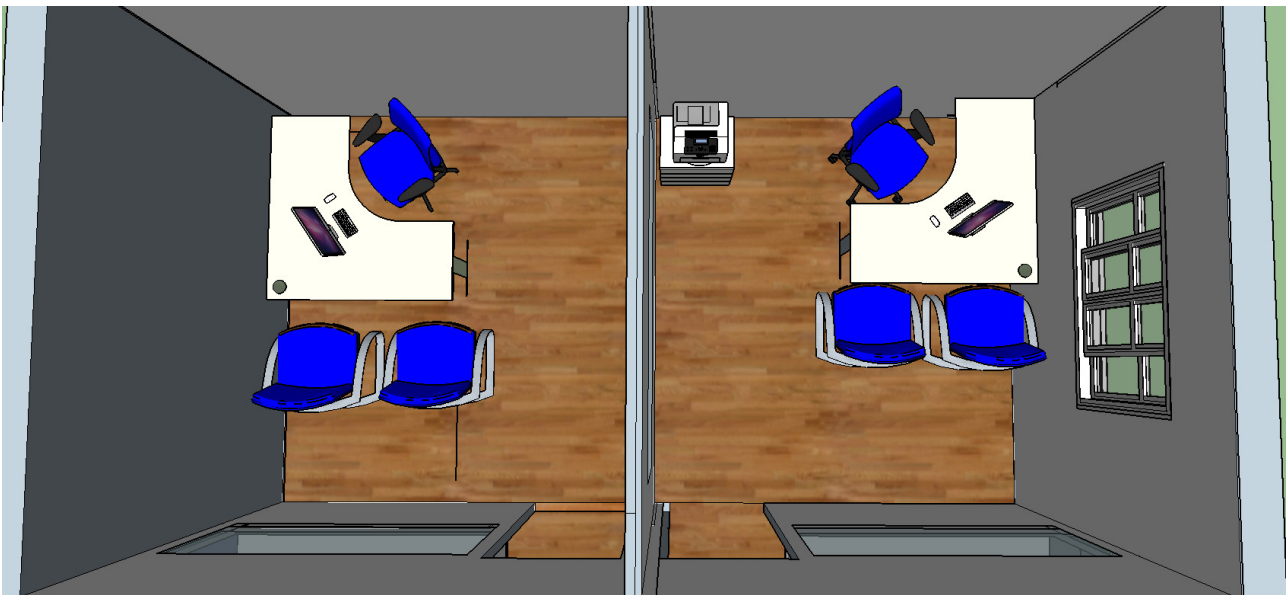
SALAS DE CHEFE / ENCARREGADA: planta baixa
